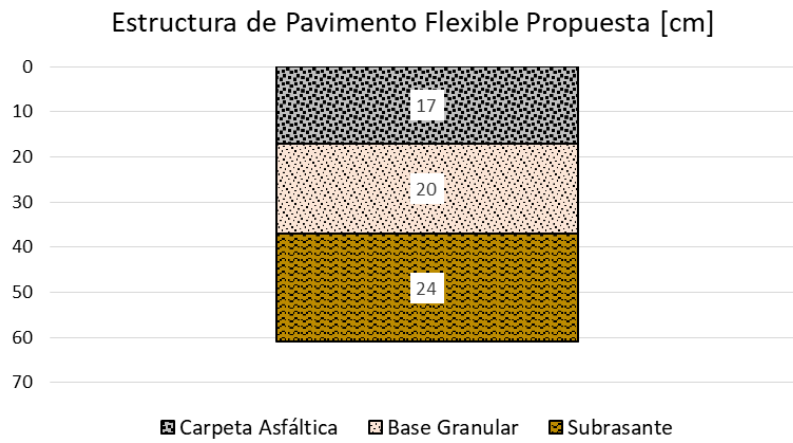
Estructura de Pavimento Flexible Propuesta
